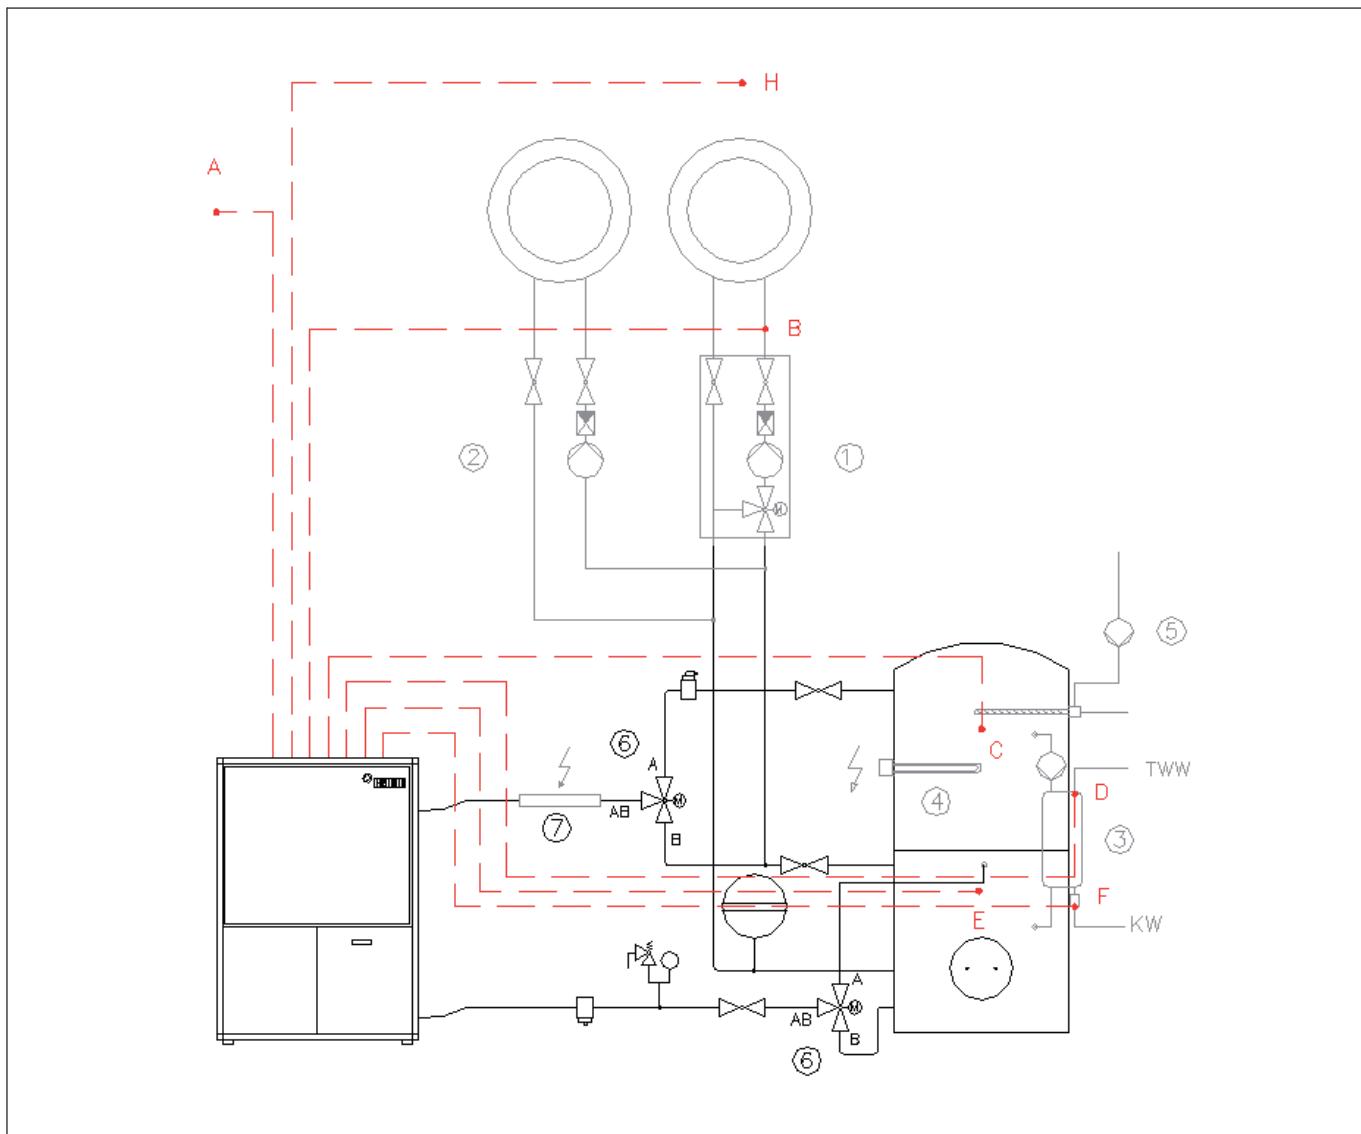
Модель установки 1 - отопление и подготовка горячей питьевой воды
